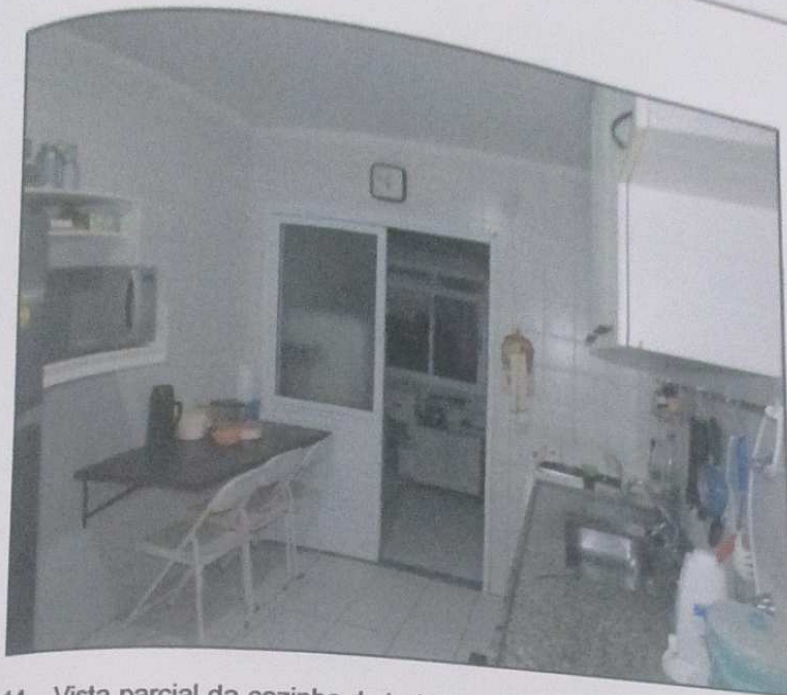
Vista parcial da cozinha do imóvel avaliando. Observa-se o piso em cerâmica e paredes azulejadas até o teto. Nota-se a porta balcão que divide a cozinha e a área de serviço.
